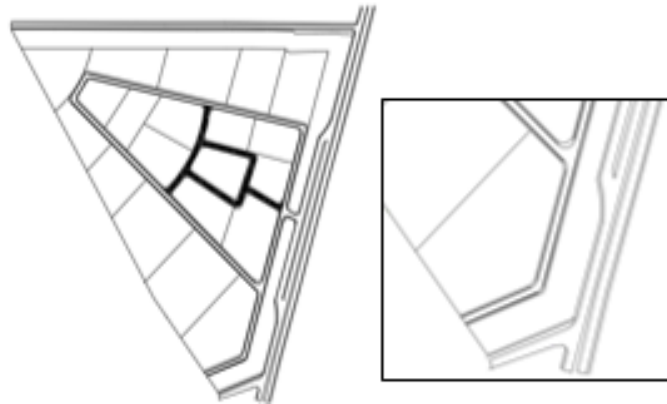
Ubicación del terreno en la propuesta arquitectónica(2018)
